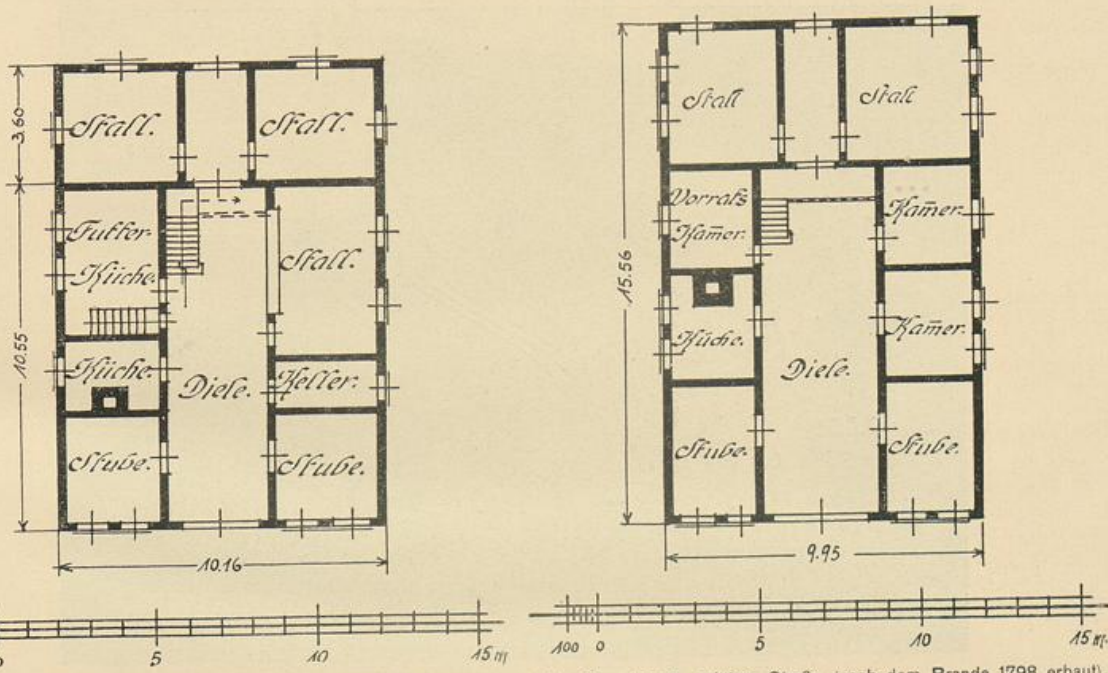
Lügde, untere Straße (vor dem Brande 1796 erbaut).
